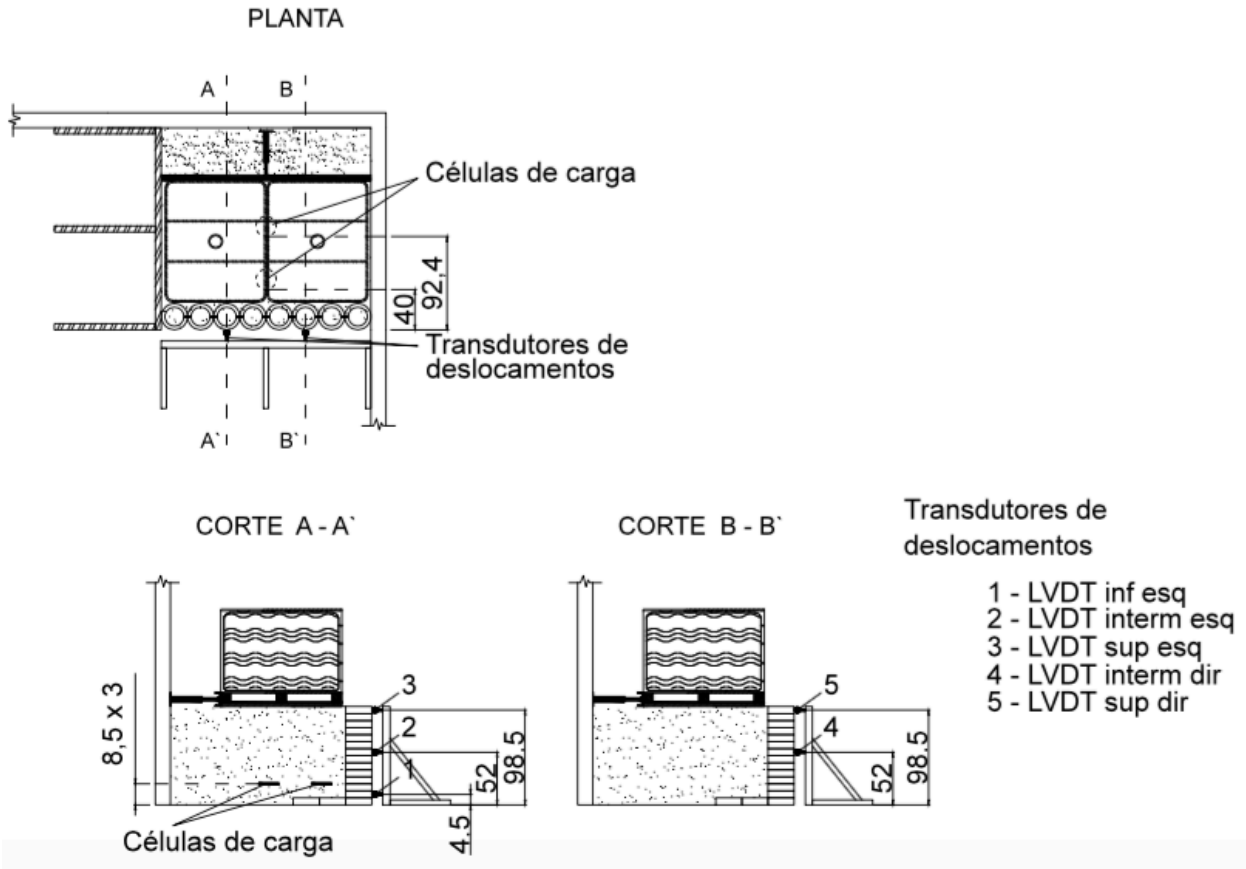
Esquema em planta e em corte com a posição da instrumentação.
